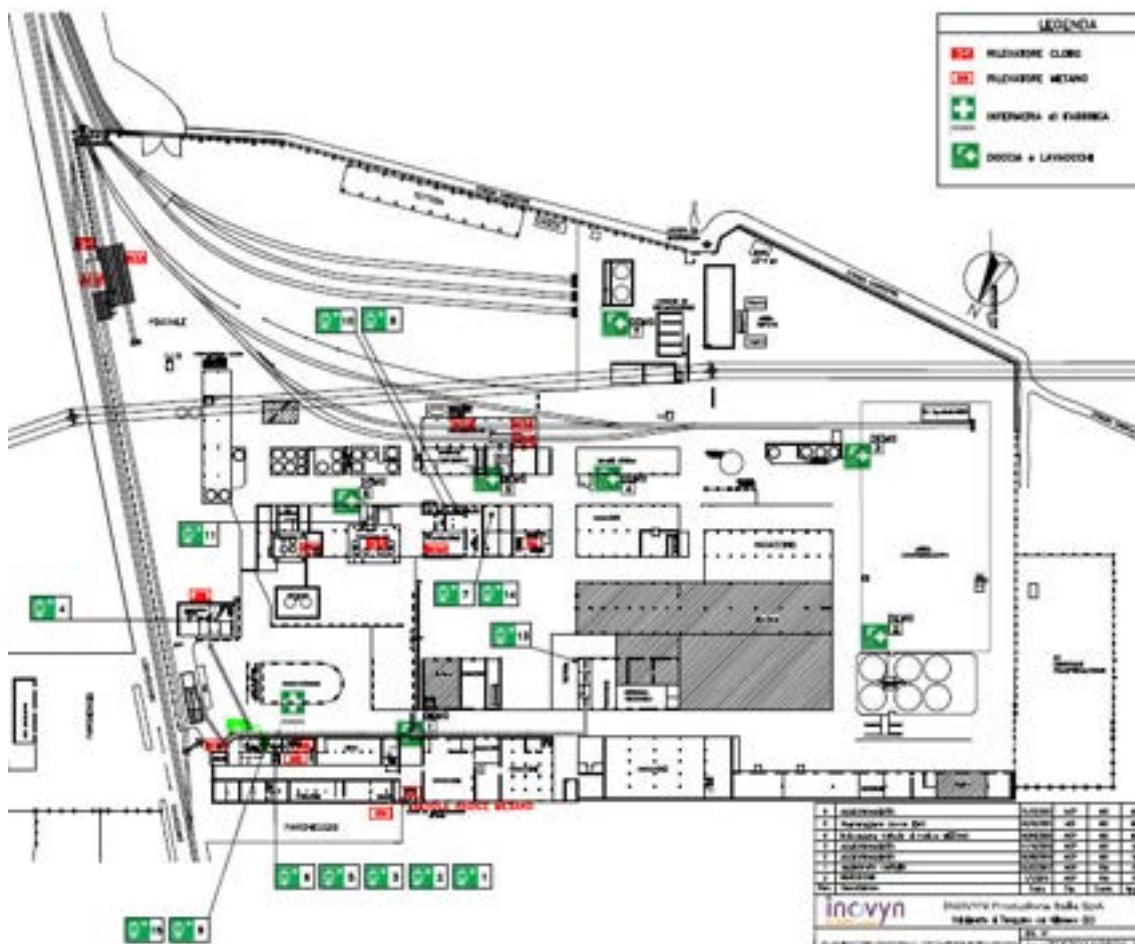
Planimetria dotazioni sicurezza stabilimento di Tavazzano
